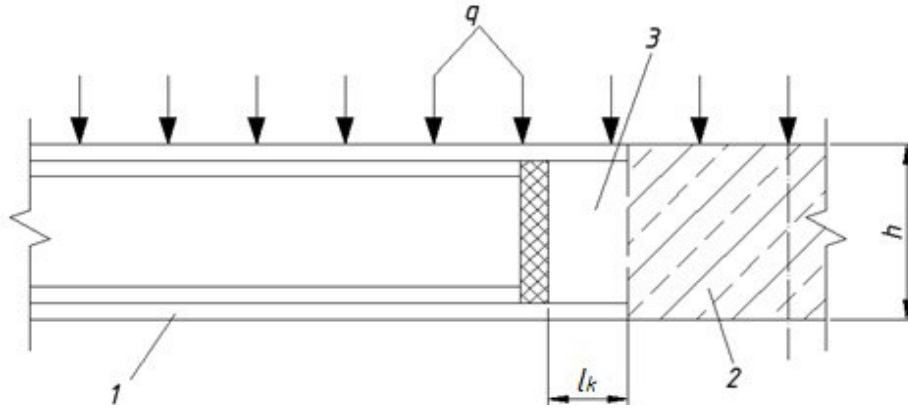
До розрахунку стику багатопустотних плит з несучим ригелем на дію вертикального навантаження (загальний вигляд стику): 1 – багатопорожниста плита; 2 – несучий ригель; 3 – бетонна шпонка
